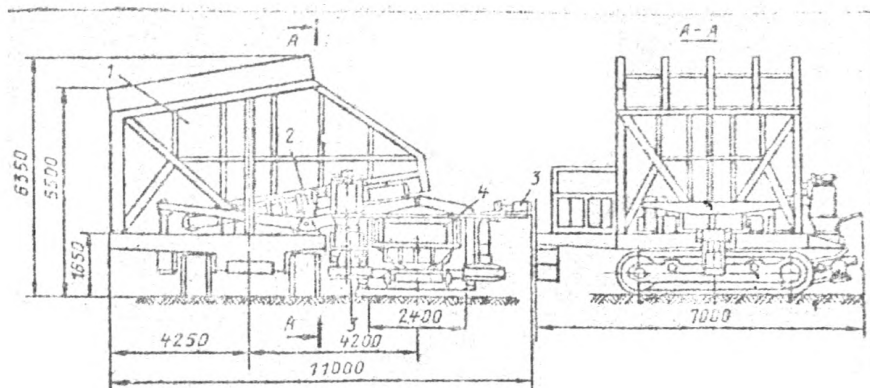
Схема забойного загрузочного устройства типа самоходного агрегата:
